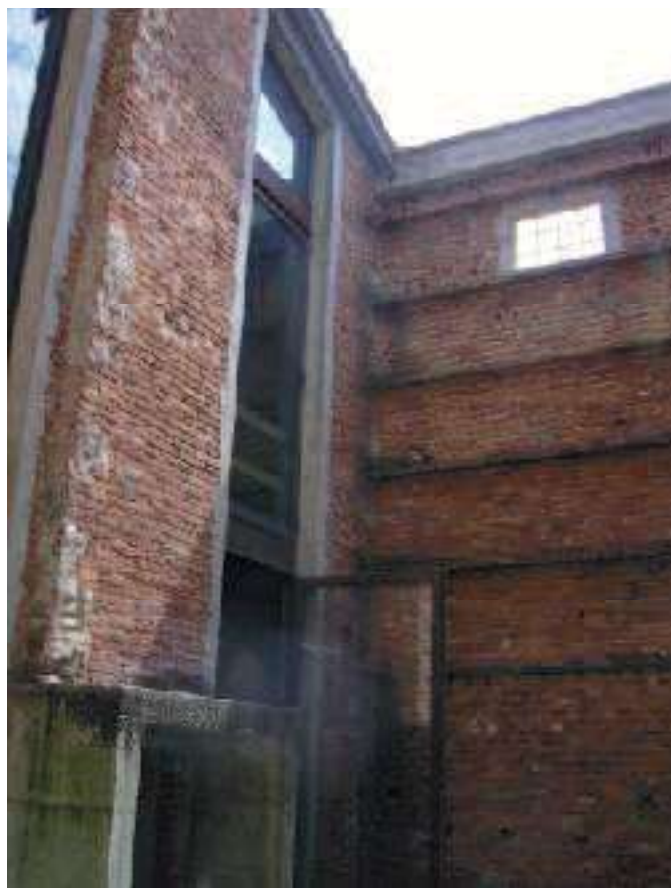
u.i. Sub.10 (corte) -lotto n.3 -
